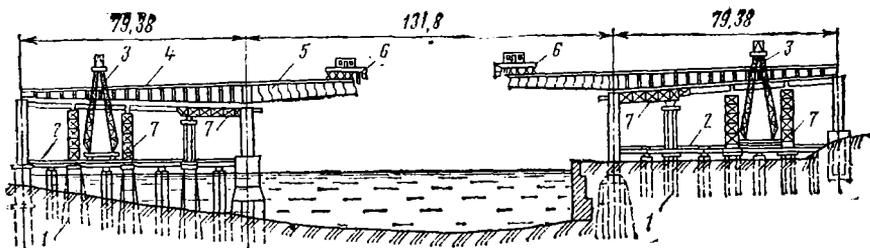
Схема сборки балочно-консольного пролетного строения:
